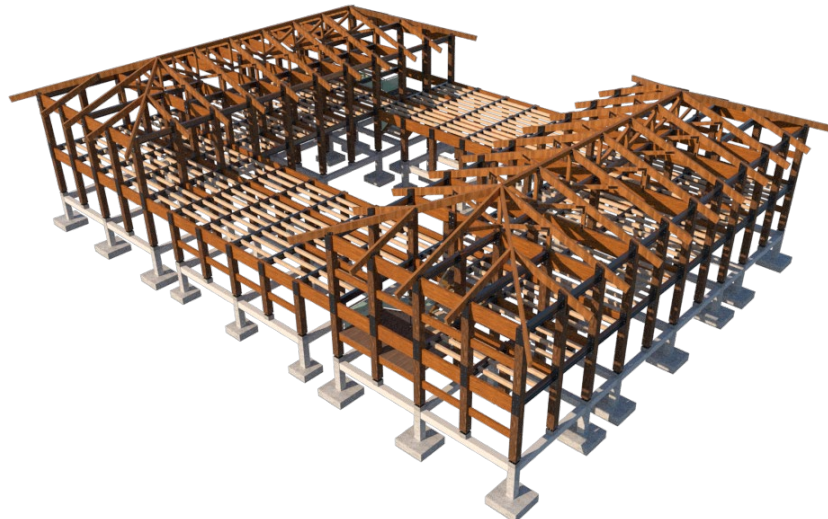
Modelo 3D del sistema estructural. Soria, 2024
